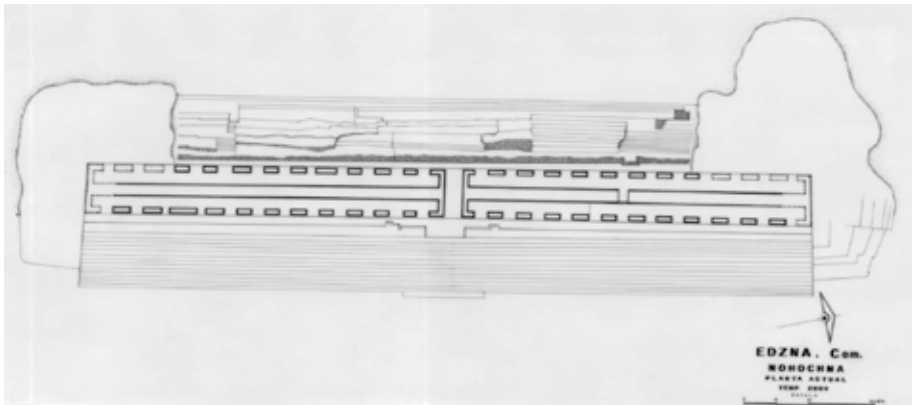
Planta del Nohochná mostrando los sectores excavados.
